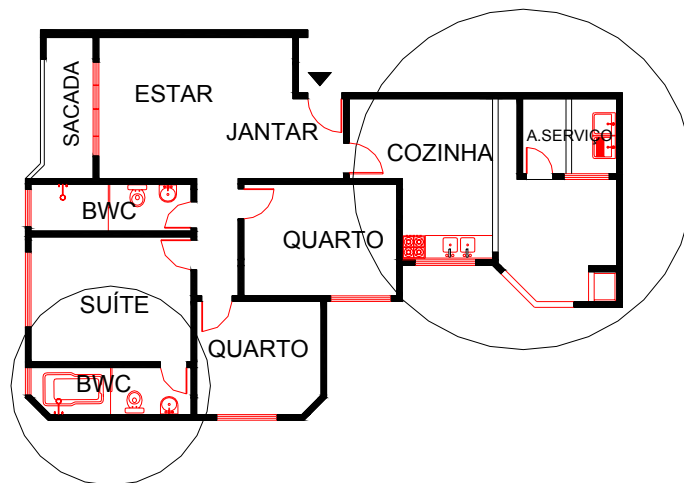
Planta Baixa do apartamento 502 – Estudo de caso B.
